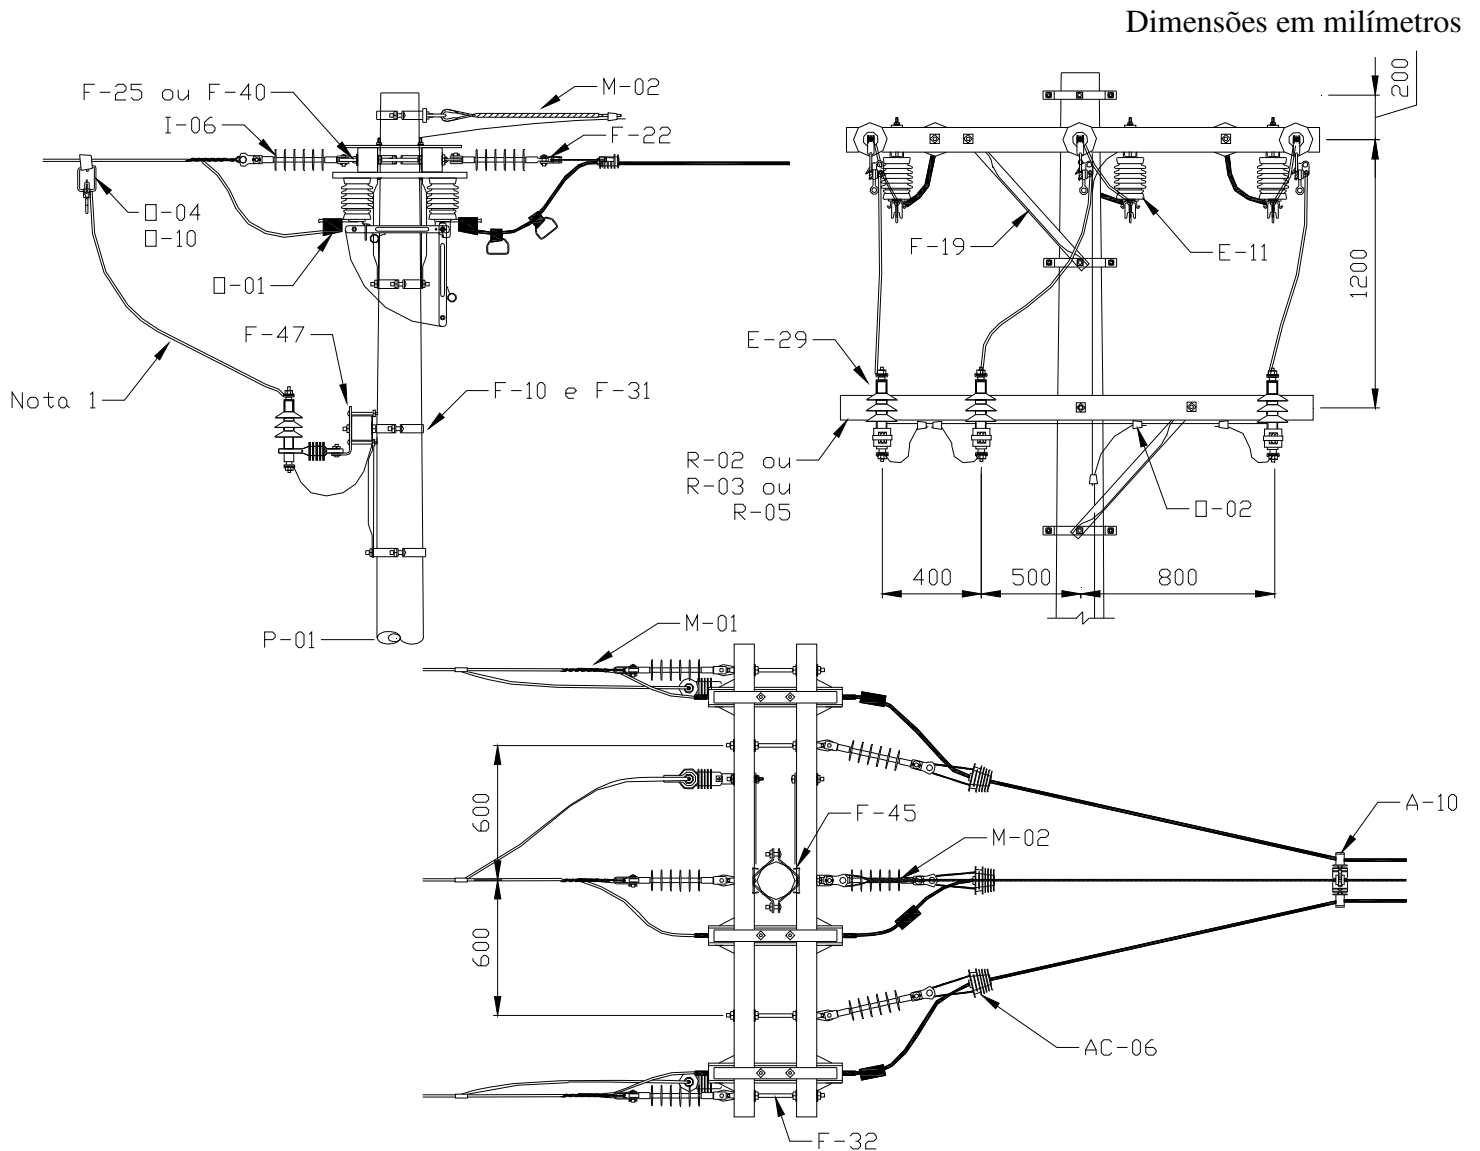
Estrutura CE3.B3 PR – Poste de Concreto de seção DT
